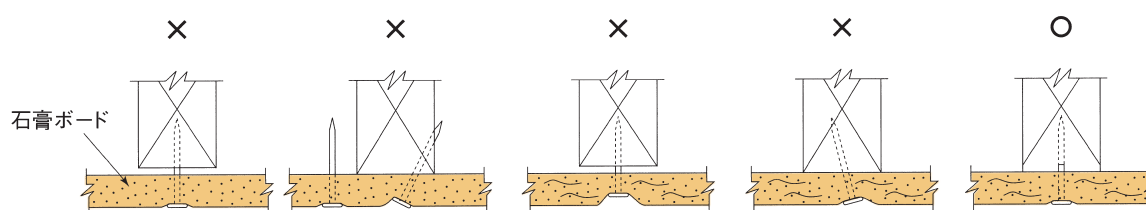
石膏ボードの釘留付け例 (USING GYPSUM BOARD FOR WALLS & CEILINGS '91 GYPSUM ASSOCIATION)
